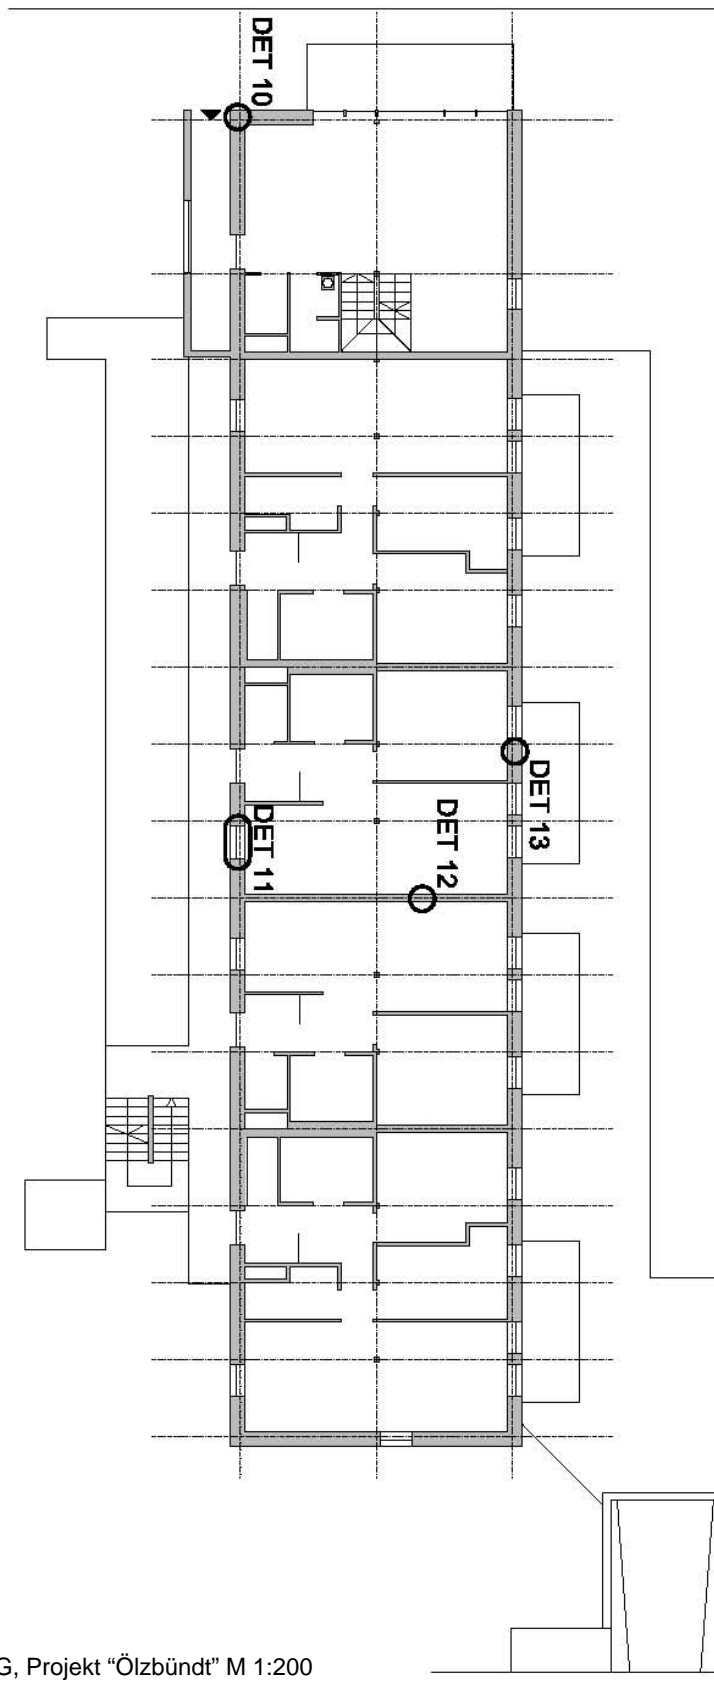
Grundriss EG, Projekt "Ölzbündt" M 1:200
